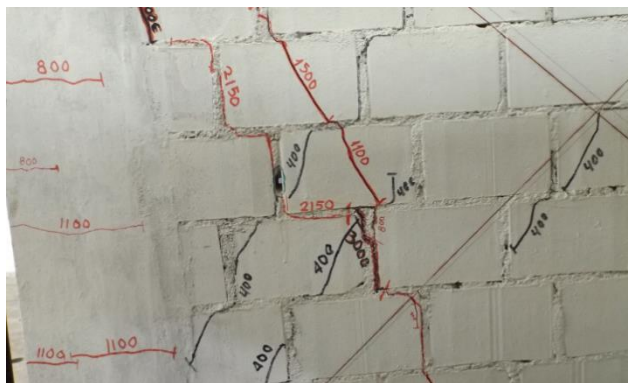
Grieta de más grietas paralelos a las líneas del mortero para una distorsión 1/400.
